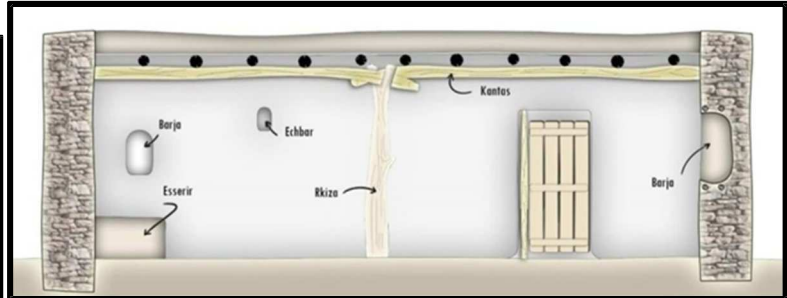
coupe montre les rondins de bois (poteau ,poutre)
